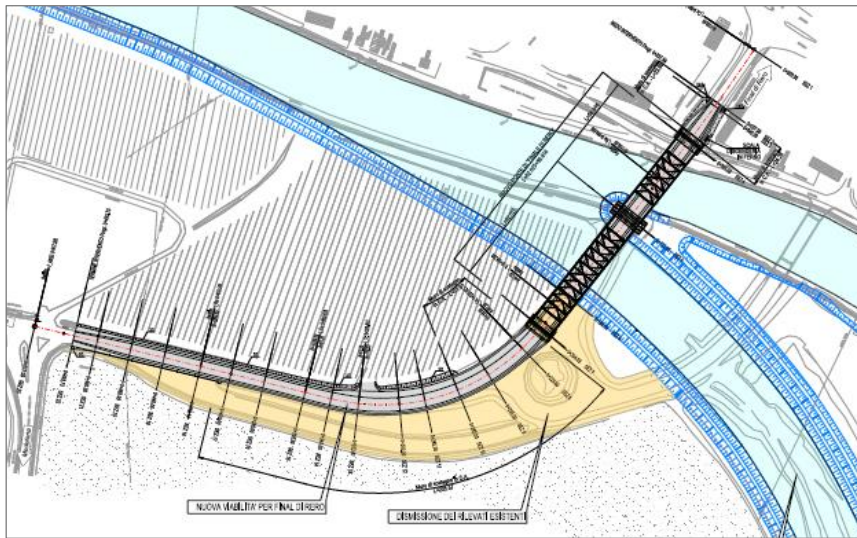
Stralcio planimetrico del nuovo Ponte di Final di Rero
